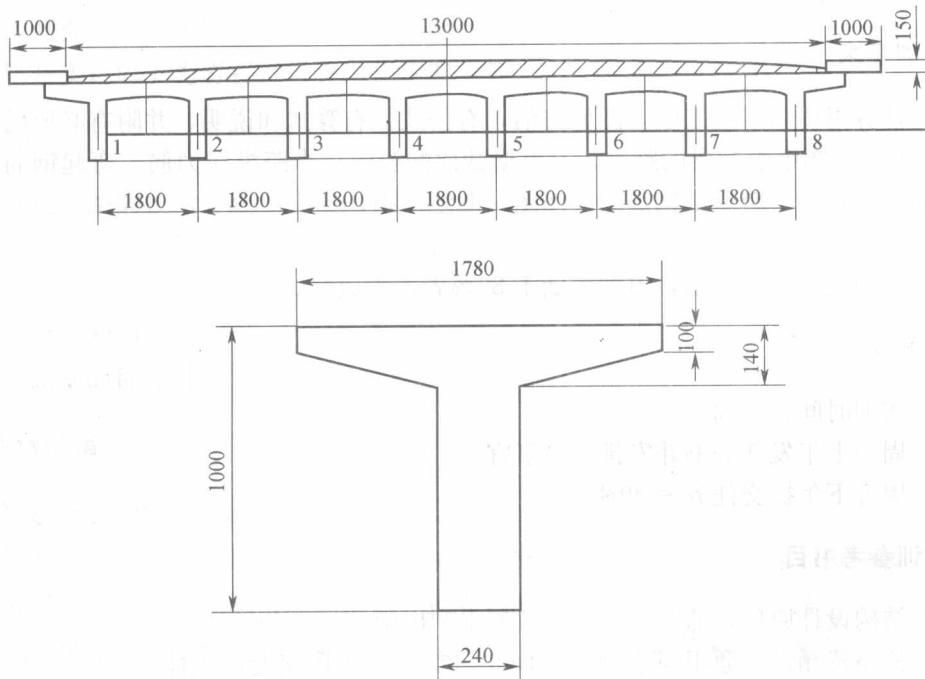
装配式钢筋混凝土简支 T 梁的截面尺寸 (单位: mm)
